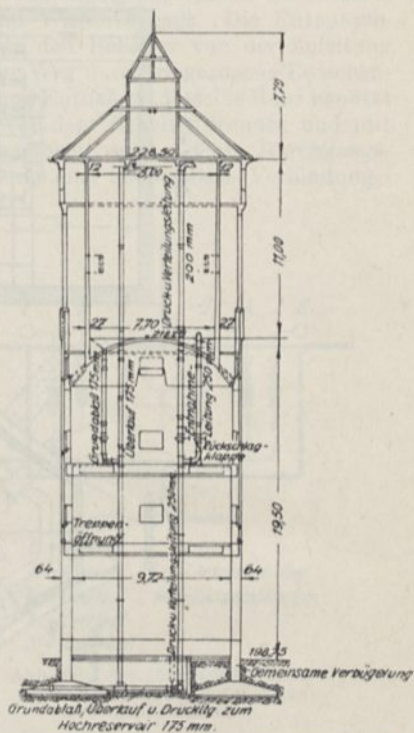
Wasserturm in Eisenbeton (Böckingen), nach »Das Gas- und Wasserfach«, Jahrgang 1933.
